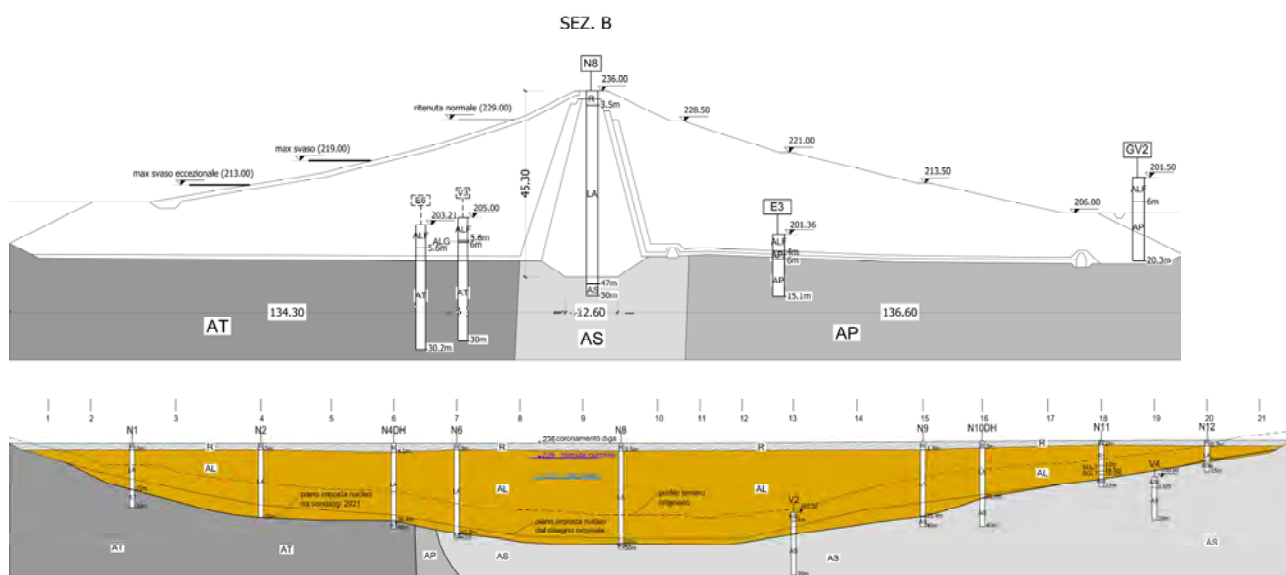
Diga di Gibbesi – Sezione trasversale e longitudinale del corpo diga con indicazione dei terreni di fondazione
